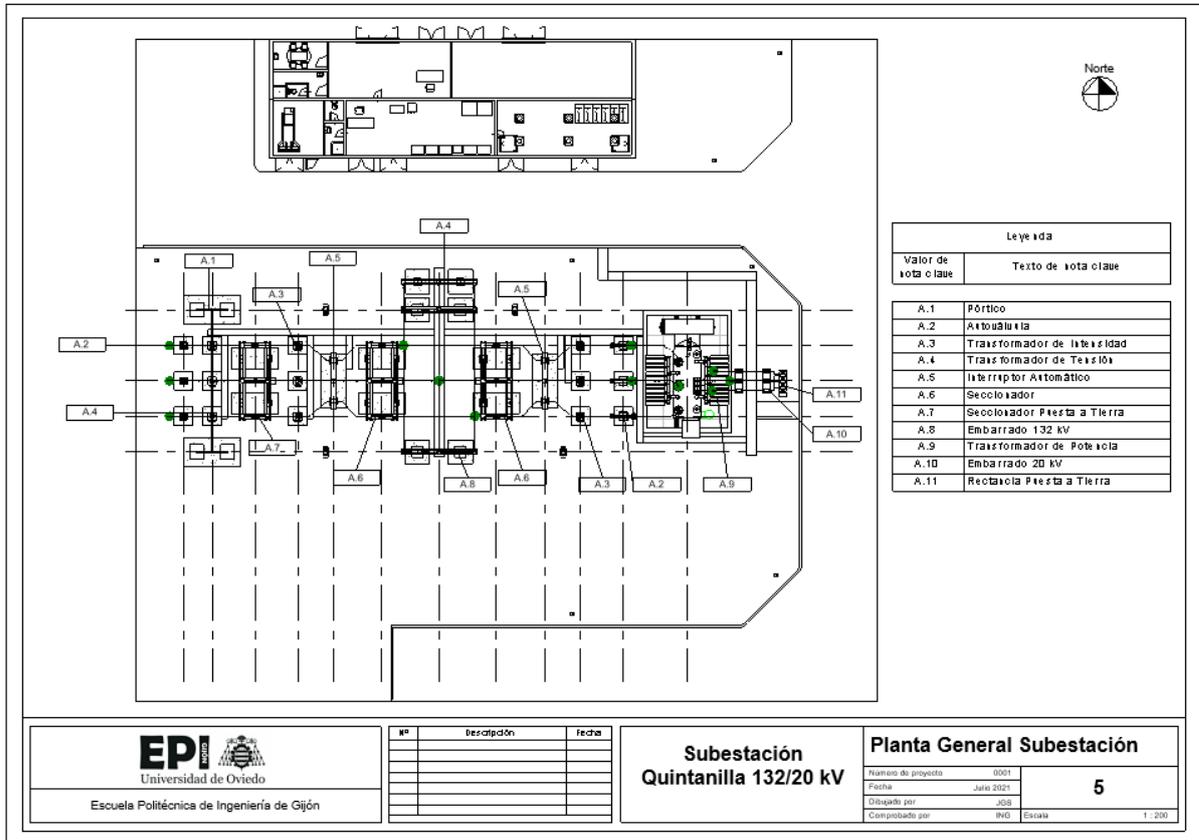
Planta General de la subestación (Elaboración Propia)
